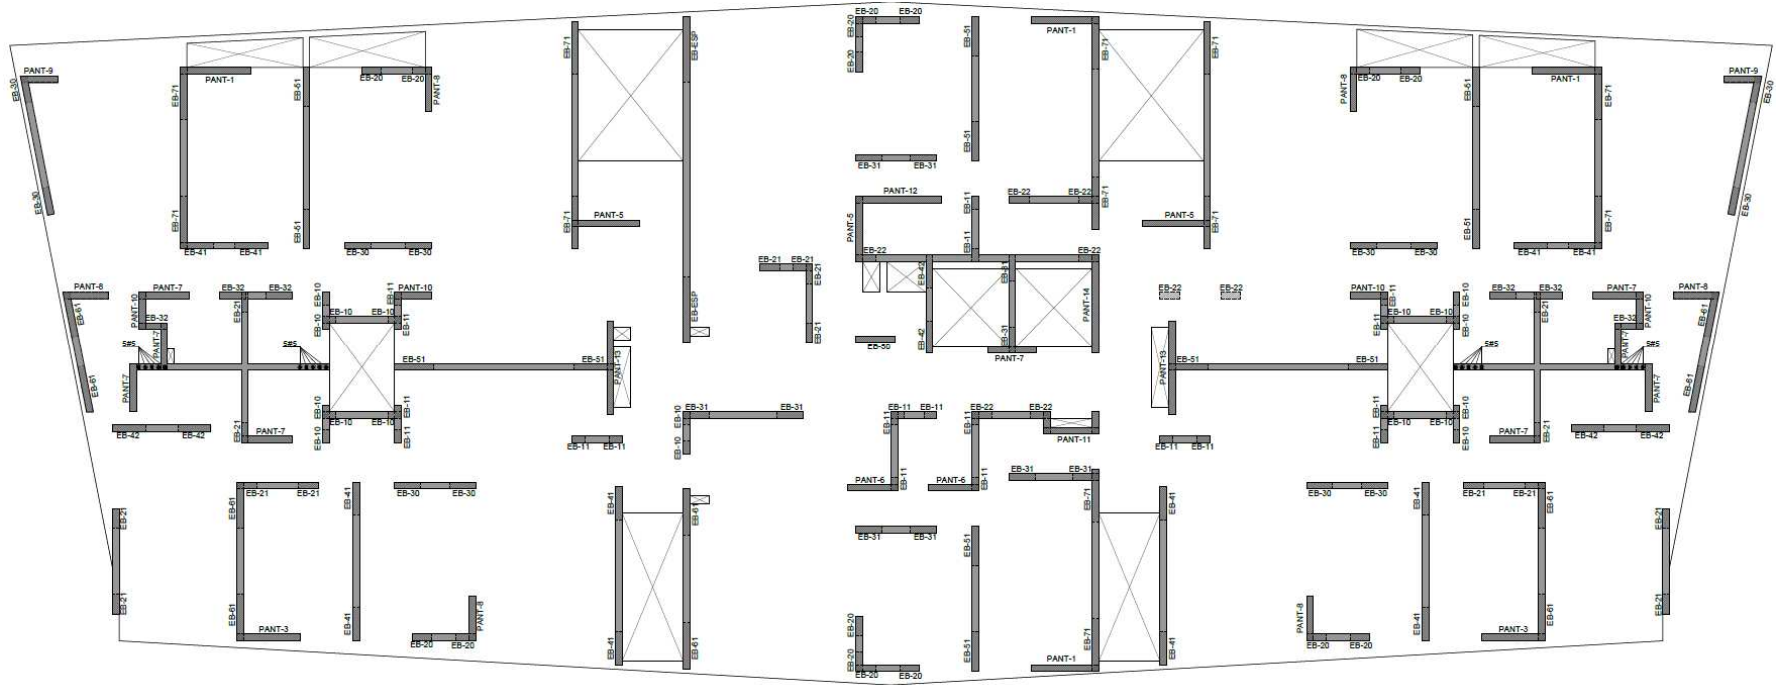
Planta de refuerzo adicional en muros de piso 1. Fuente: Elaboración propia.
